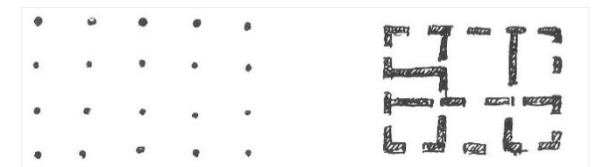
Croqui demonstrando o uso de pilotis versus o sistema tradicional de construção em planta baixa. Fonte: Colquhoun, 2004 pg. 116
